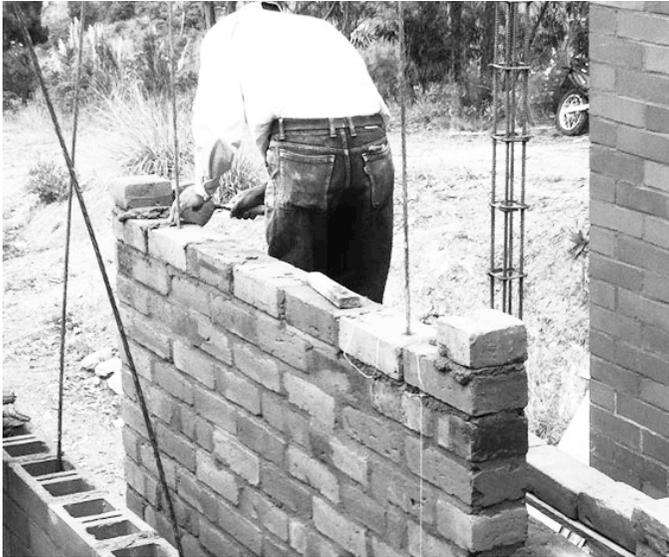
Muro de ladrillo "panelón" artesanal para presforzarse en proceso de construcción.
